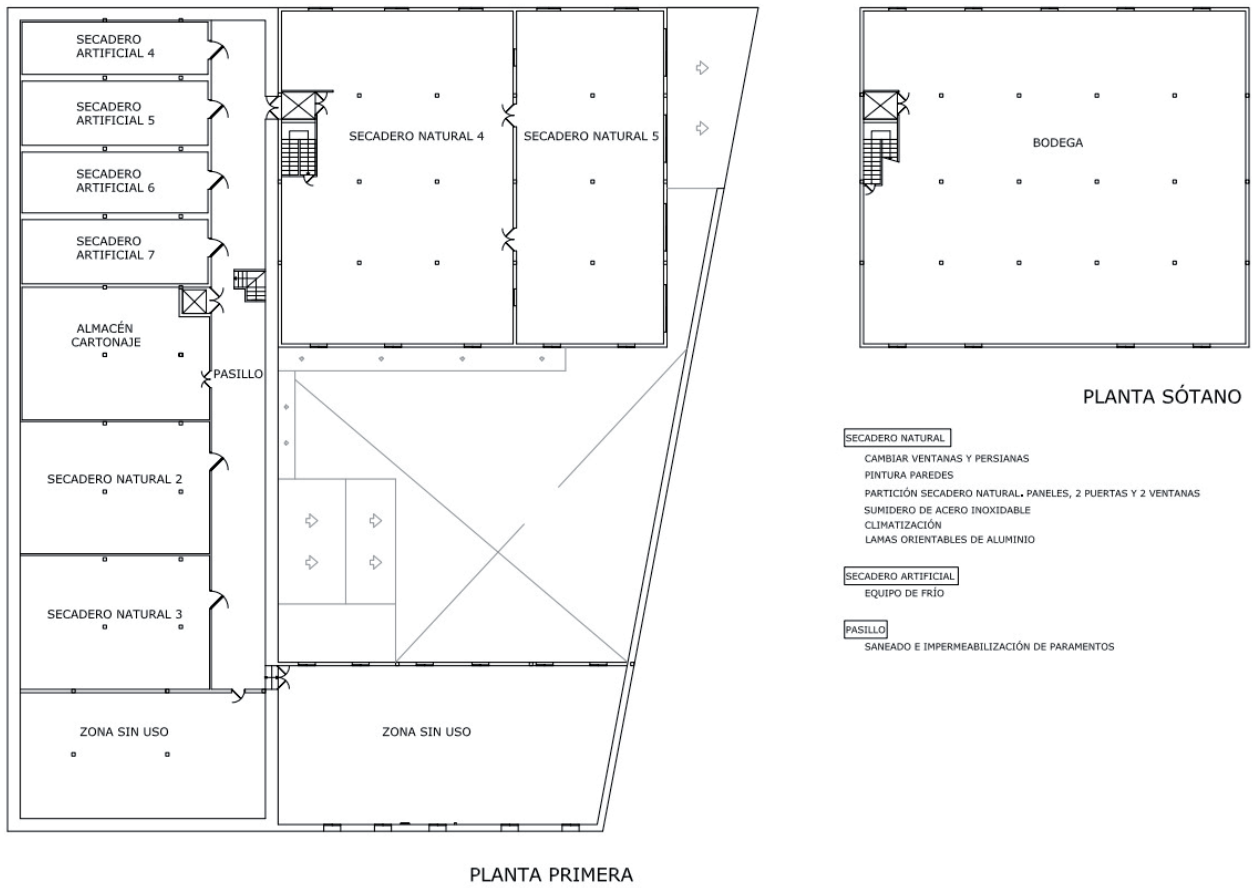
Situación proyectada de las instalaciones de la planta primera y sótano
